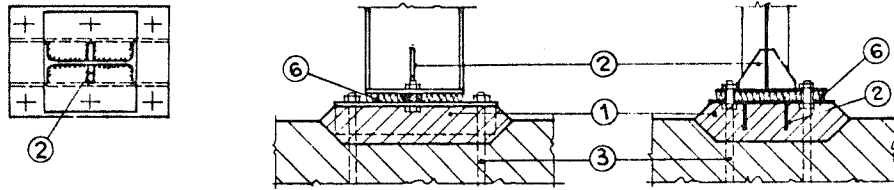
Columna de perfil laminado: base articulada (ref. 5.57)
